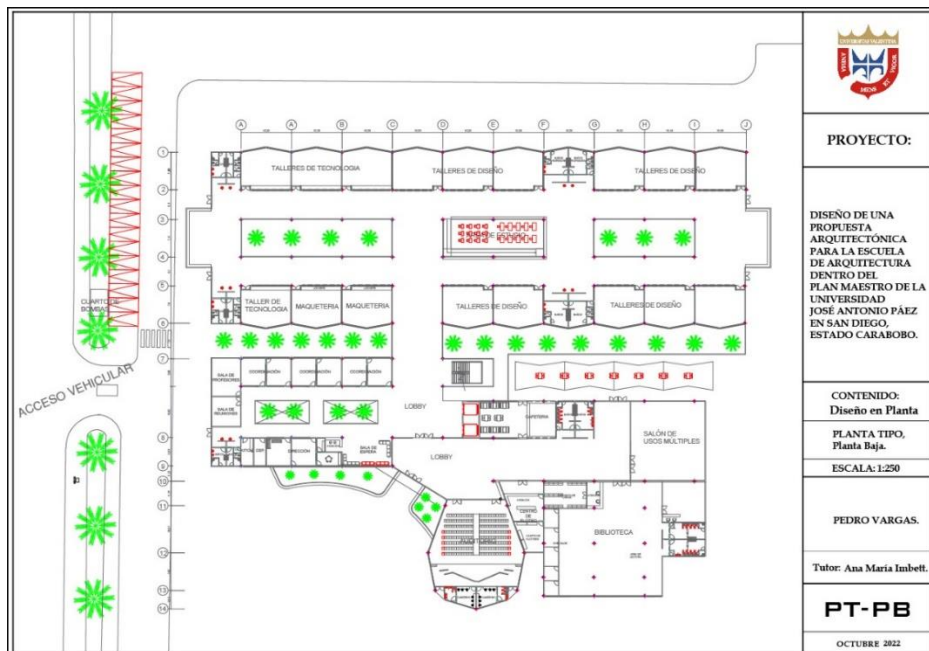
Plano de diseño en vista de planta para Planta Baja.
